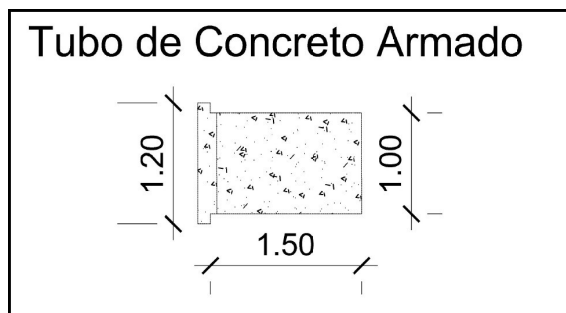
DIMENSÕES DOS TUBOS DE CONCRETO ARMADO UTILIZADOS NA PROPOSTA DE CANALIZAÇÃO
